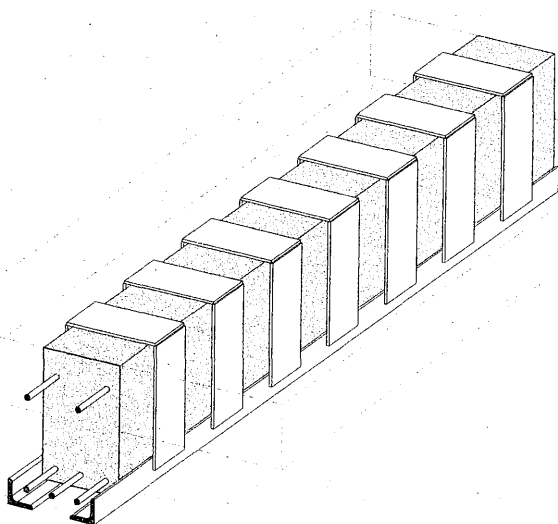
18. Refuerzo de vigas con angulares y presillas.
